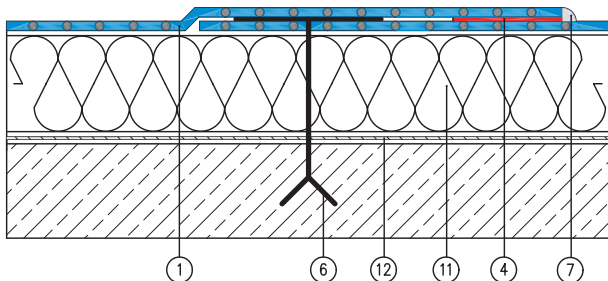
Механически прикрепленное покрытие крыши из мембраны FATRAFOL на бетонном основании
